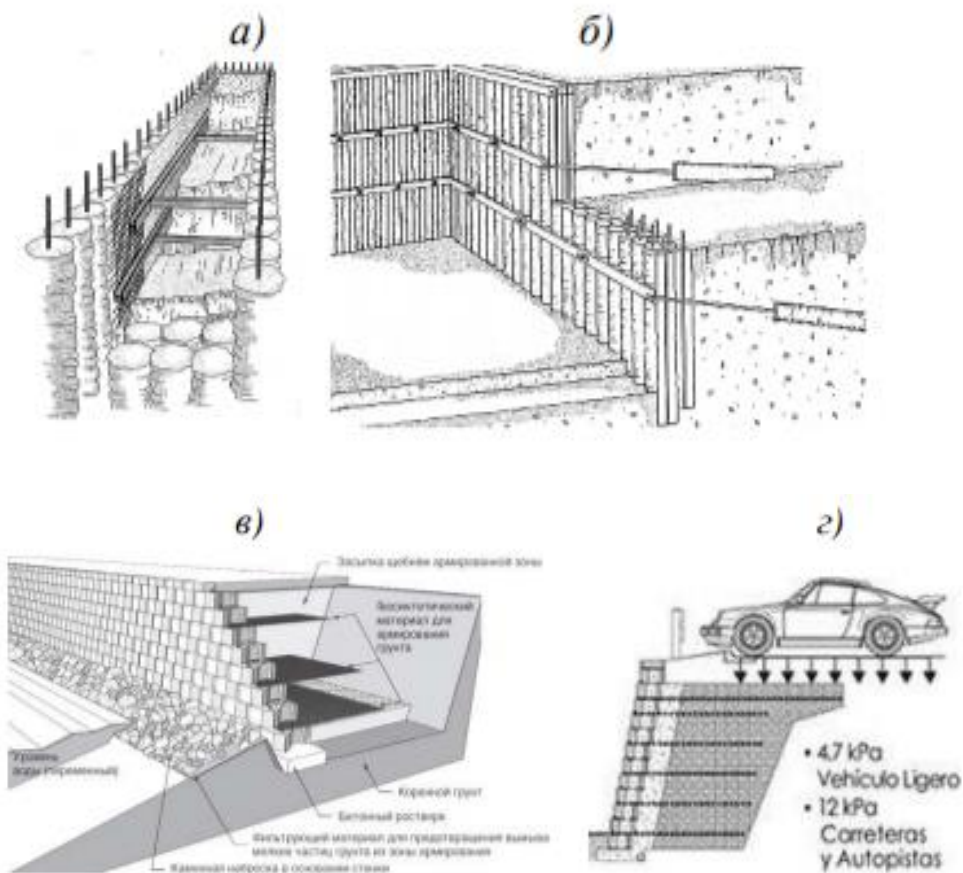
Принципові схеми споруд з вертикально і горизонтально армованого ґрунту. а - вертикальні армуючі елементи в основі споруди і в стінах огорожі протяжного котловану з кріпленням розпірками; б - кріплення стін глибокого котловану за допомогою вертикальних армоелементів-шпунтів з ґрунтовими анкерами; в - підпірна стіна з збірних бетонних блоків, що утримується в рівновазі від дії бічного тиску засипки щебнем, армованим геосинтетичними сітками; г - розрахунково-конструктивна схема навантаженої зовнішнім навантаженням похилій підпірної стіни з горизонтально армованим масивом зворотної засипки з боку активного тиску.
